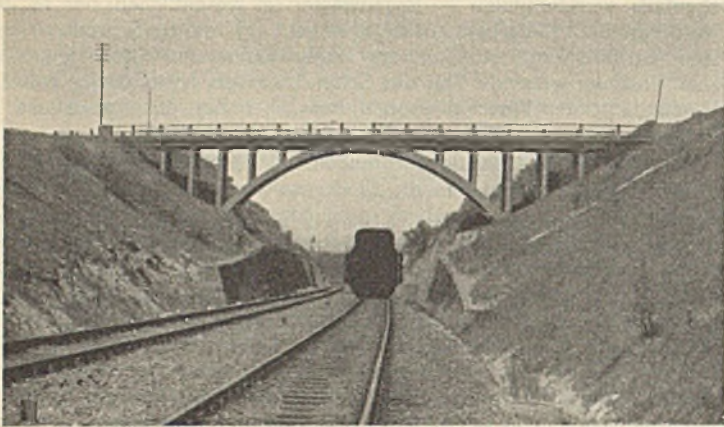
Hochliegende Wegüberführung im tiefen Bahneinschnitt.
